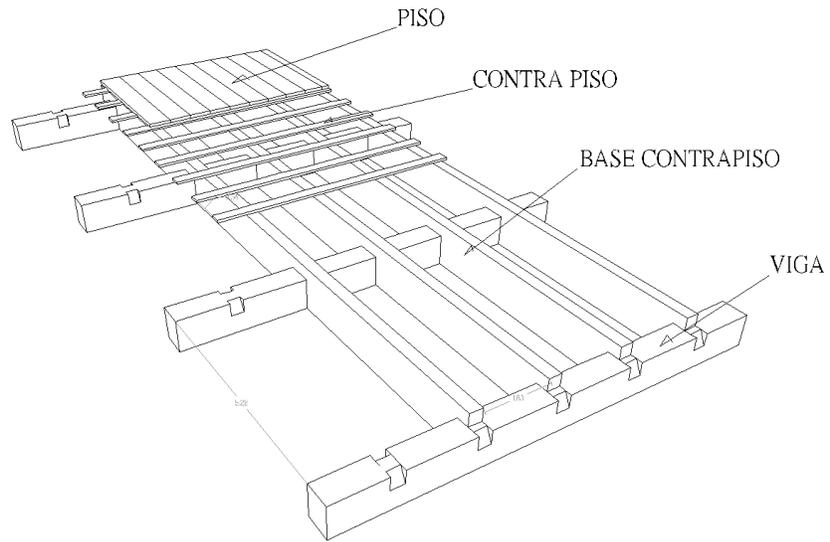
Detalle de Armado estructura - Piso de cabaña
